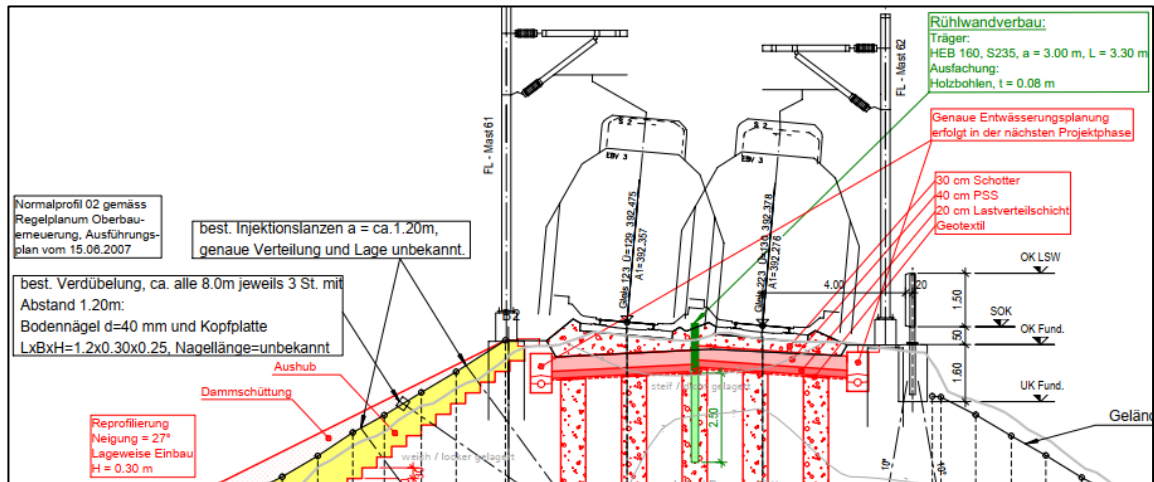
Schematischer Aufbau Ober- und Unterbau mit Entwässerung, Schnitt 10
